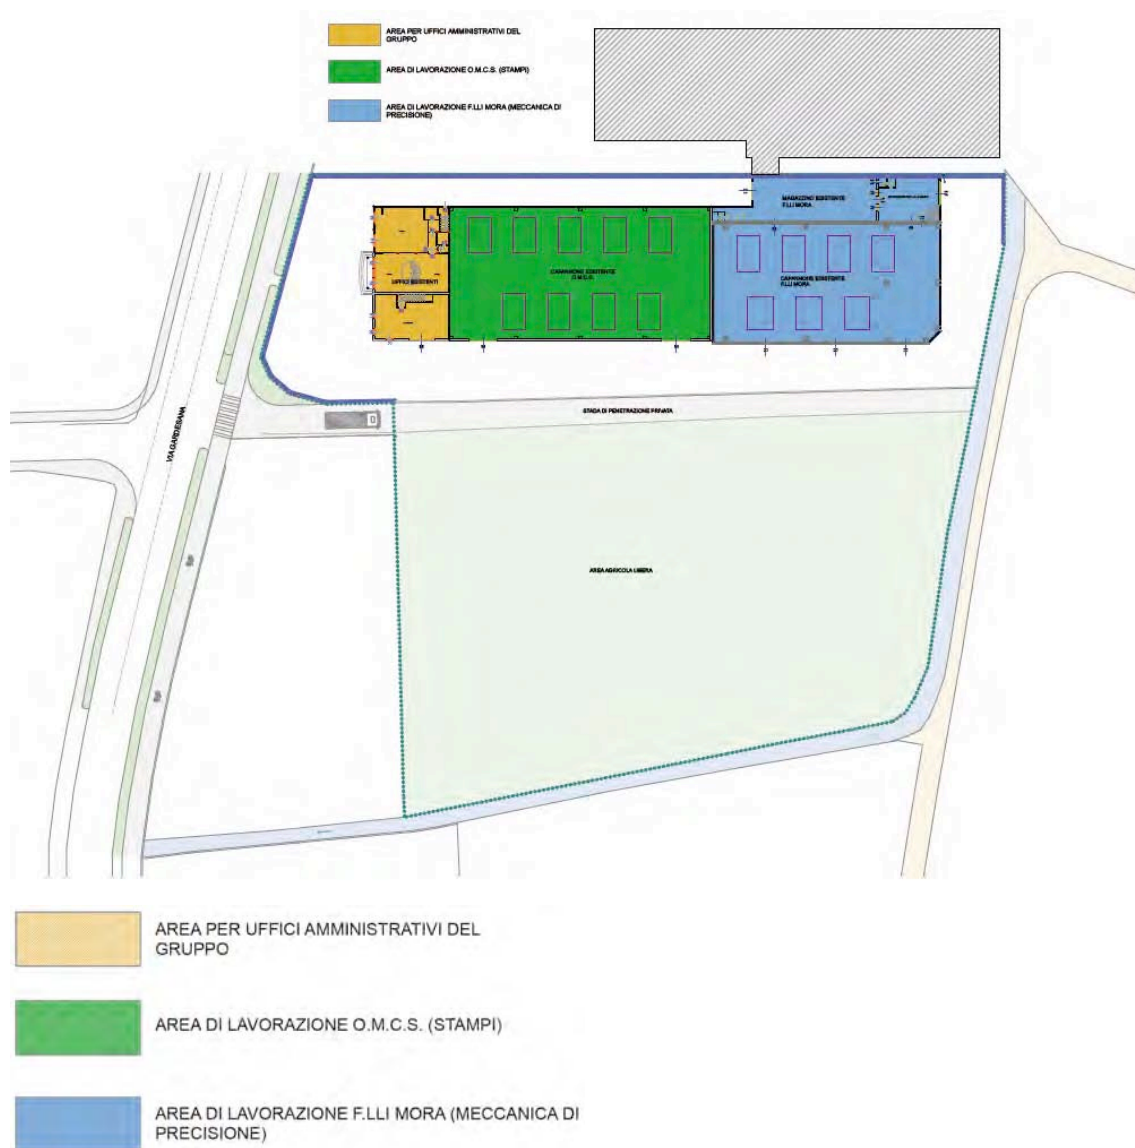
Individuazione planimetrica degli spazi occupati dalle due ditte
